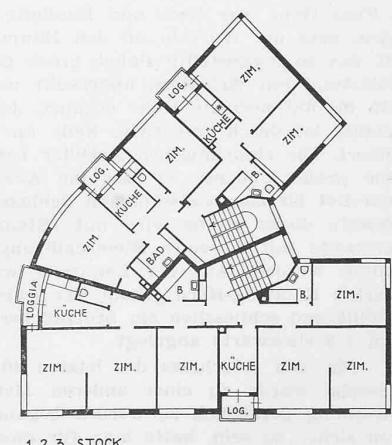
bis 5. Grundrisse 1:400 des ausgeführten Hauses, dessen Nachteile gegenüber dem ersten Entwurf (Abb. 1 und 2) aus dem Text und der obenstehenden Tabelle hervorgehen.
